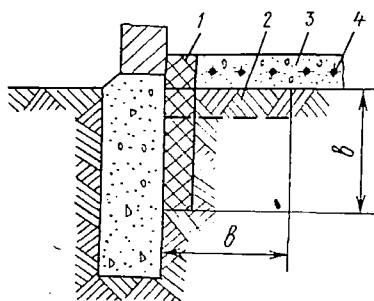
Варианты расположения тепловой изоляции по краям напольной панели у наружной стенки:
